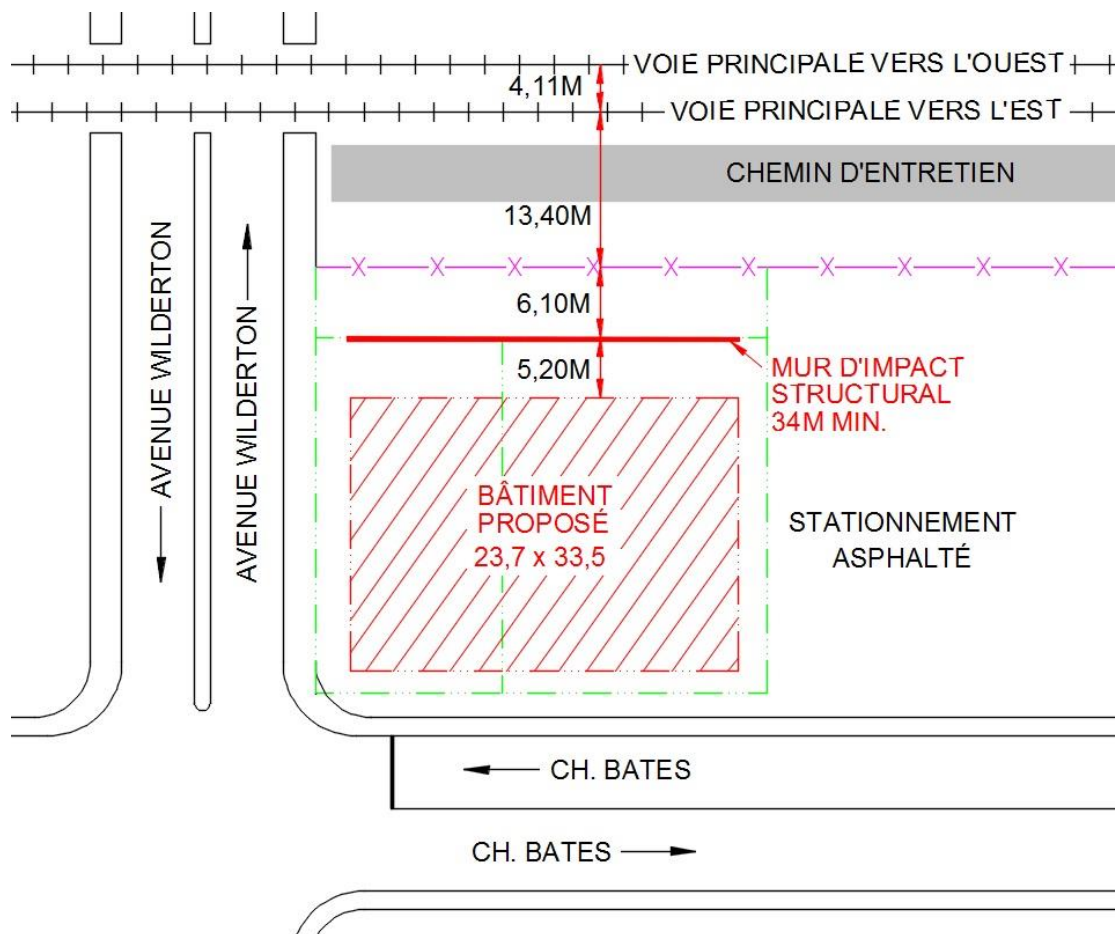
Plan d'ensemble du site proposé au PM 48.82 ADIR.
